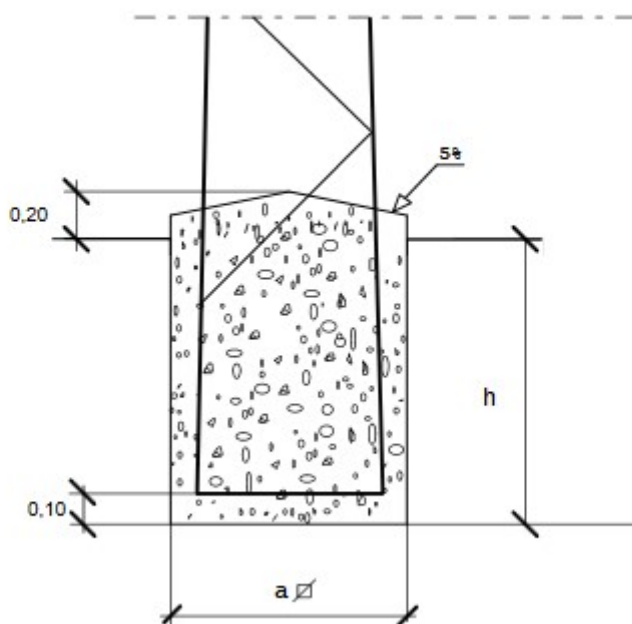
Croquis de la cimentación para los apoyos de perfiles metálicos.
